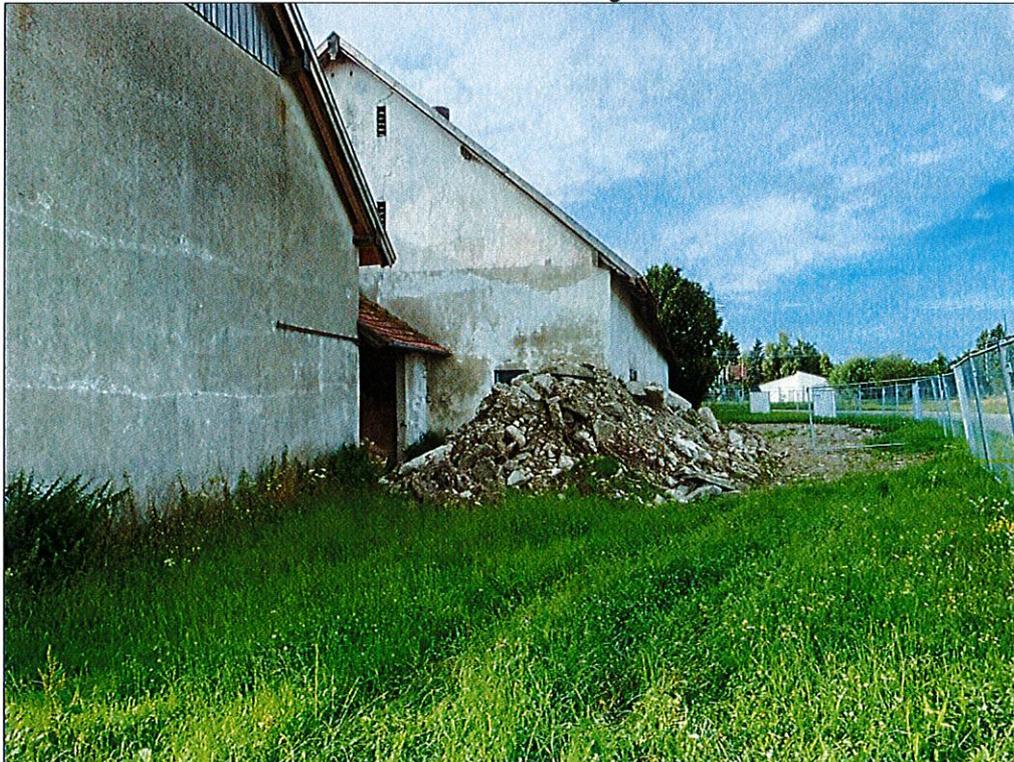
Baufläche am 03.08.2021 / Blickrichtung Süden
